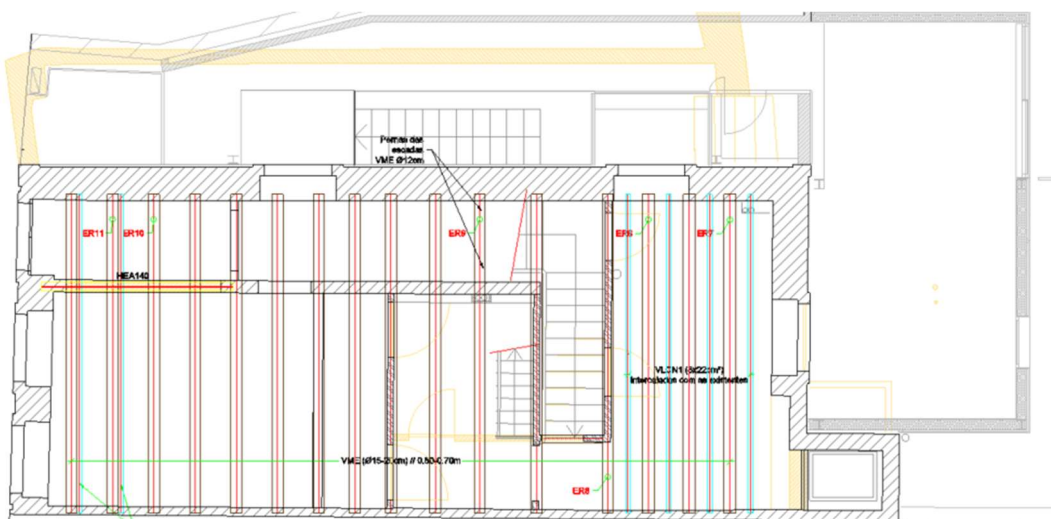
Projeto estrutural do piso 1 (Edifício 8)
